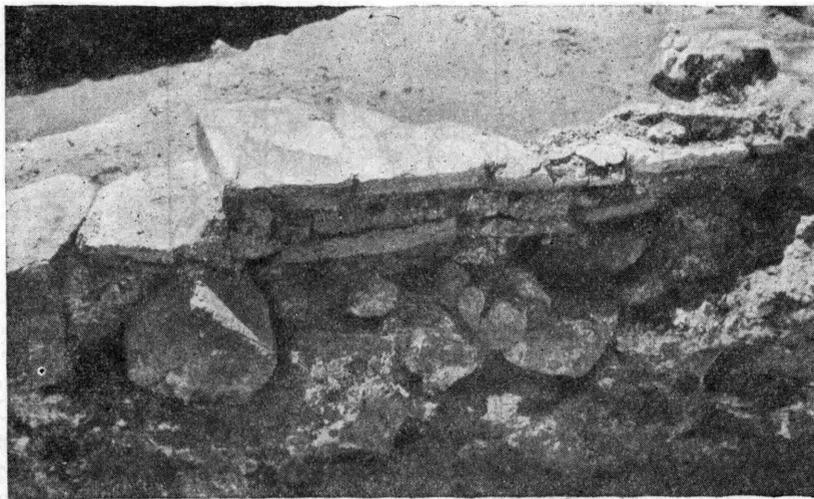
Кладка фундамента южной стены с двумя рядами кирпичей, сохранившимися *in situ*.
